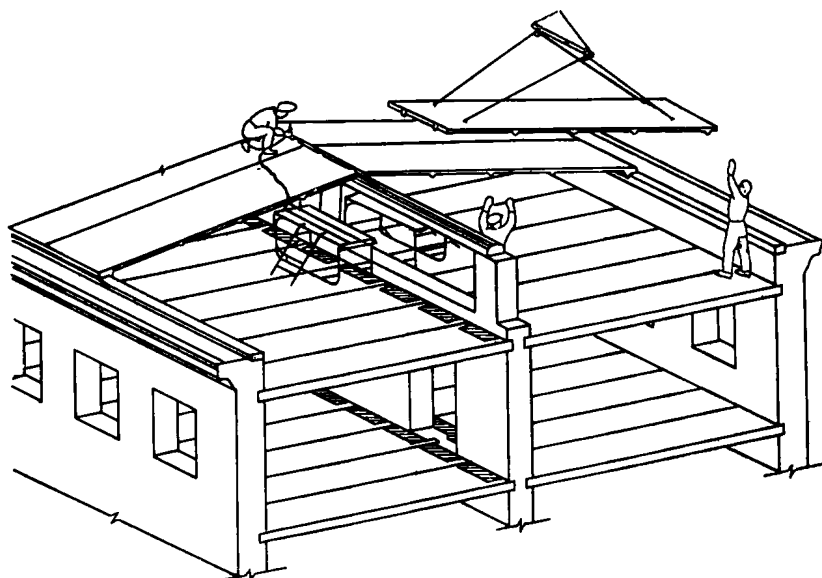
Общая схема организации работ по монтажу участка крыши из железобетонных панелей ПР
